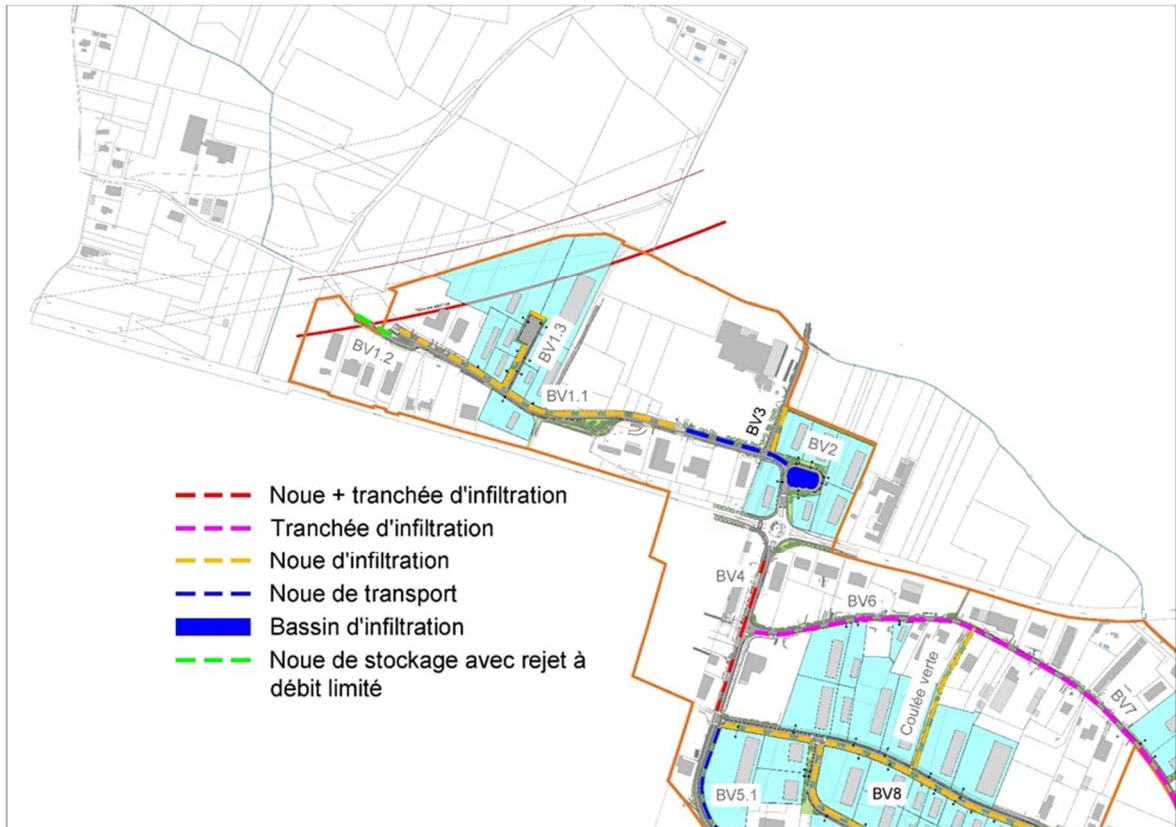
Plan de synthèse des ouvrages prévus pour la gestion des eaux pluviales – Secteur Nord (source : Etudes d'Avant-Projet, janvier 2023)
